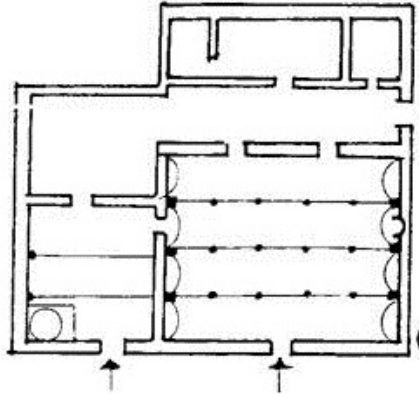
المسقط الأفقي لجامع محمود خازندار (من عمل الباحث)
